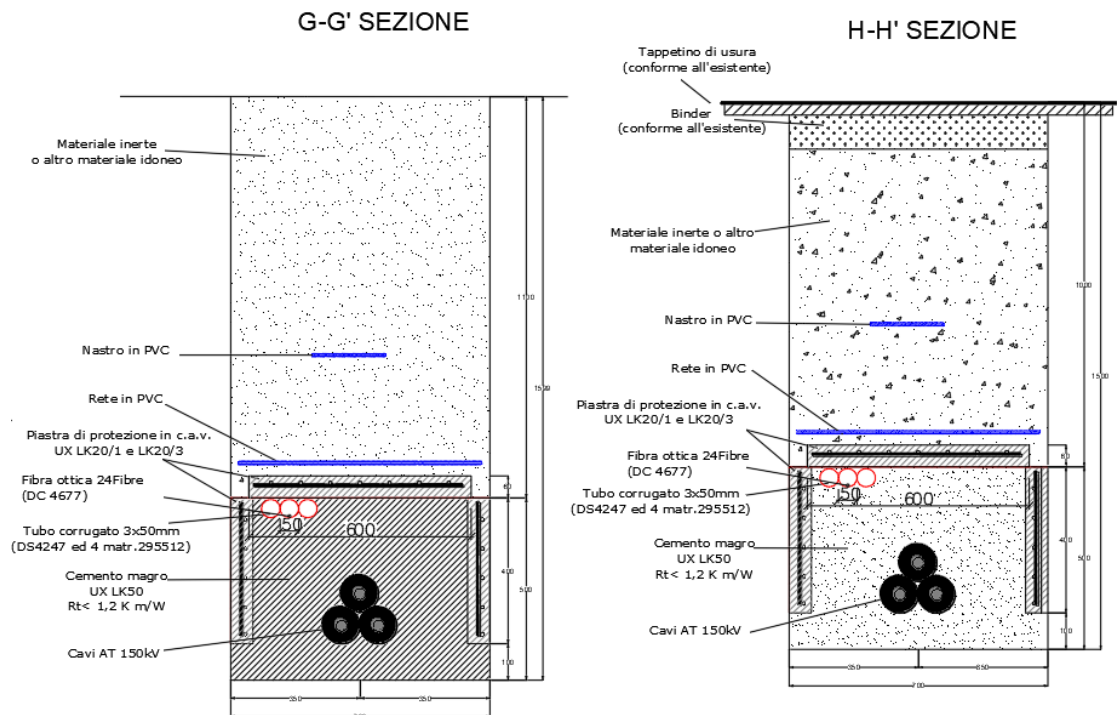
Tipico di sezione cavidotto AT su strada e su terreno agricolo
